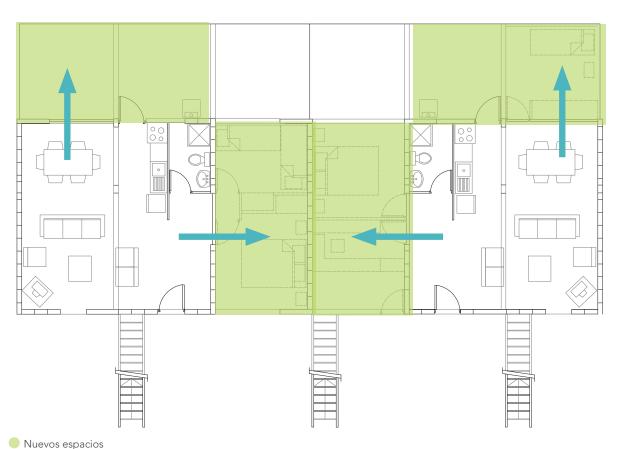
Planta Vivienda Piso 1 Nota: Elaborado por el autor
